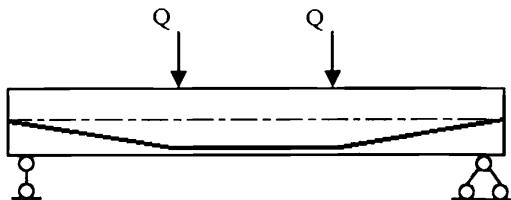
Профиль раскладки напрягаемых элементов по высоте сечения в пролете и на опорах для сосредоточенных нагрузок
